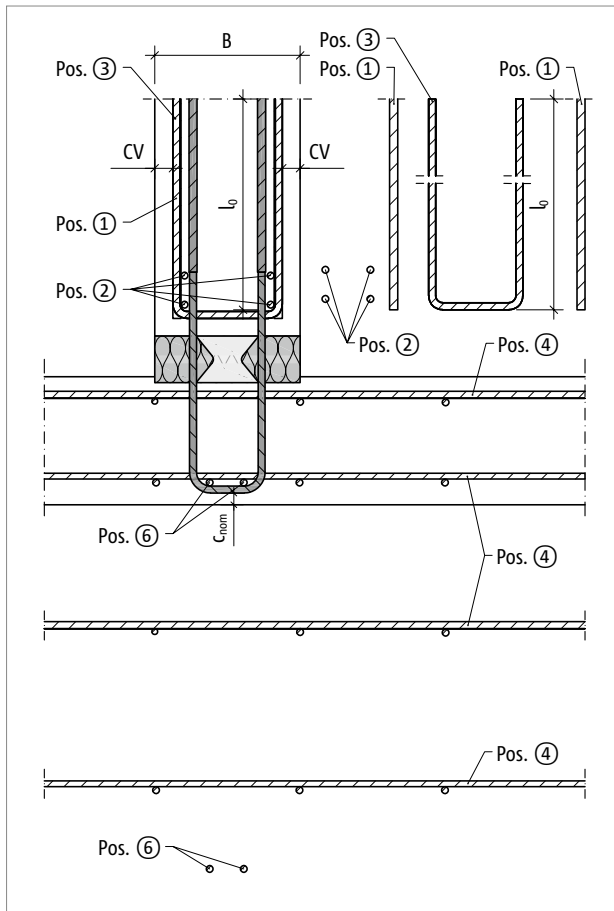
Schöck Sconnex® Typ W-NT-B: Bauseitige Bewehrung bei Zugkraftverankerung in der Decke
